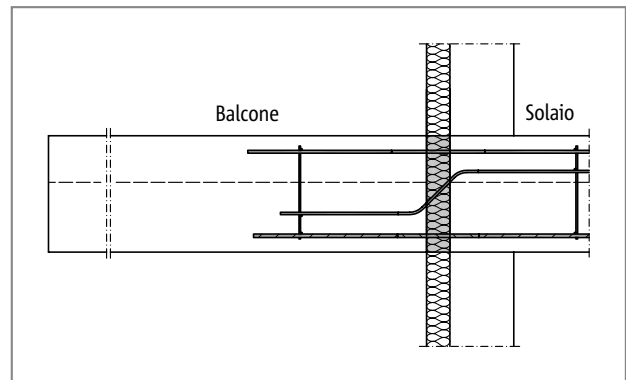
Schöck Isokorb® tipo S, balcone con travi a sbalzo
